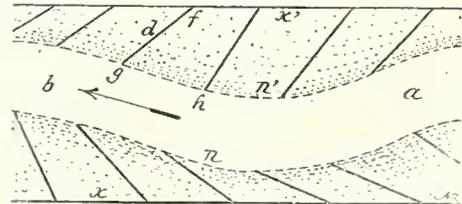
Plan des clayonnages du lit majeur d'un ruisseau
